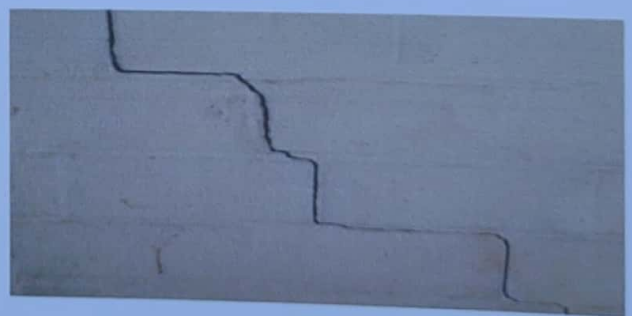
Paredes en sanitarios en mal estado por grietas.
